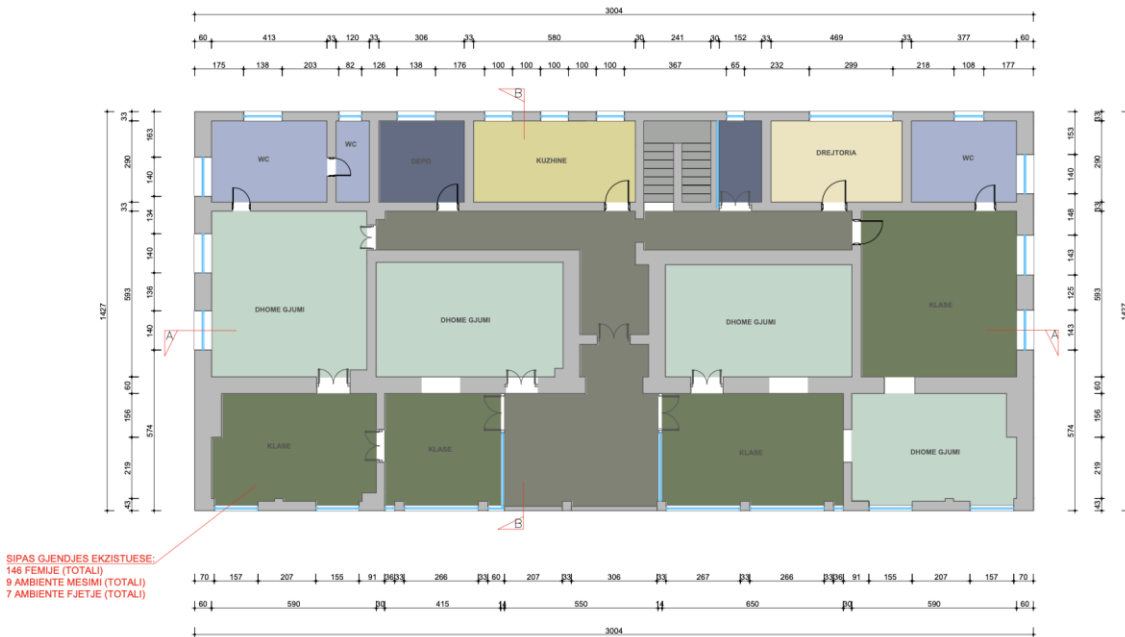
Planimetria Ekzistuese, zonimi funksional kati pare
